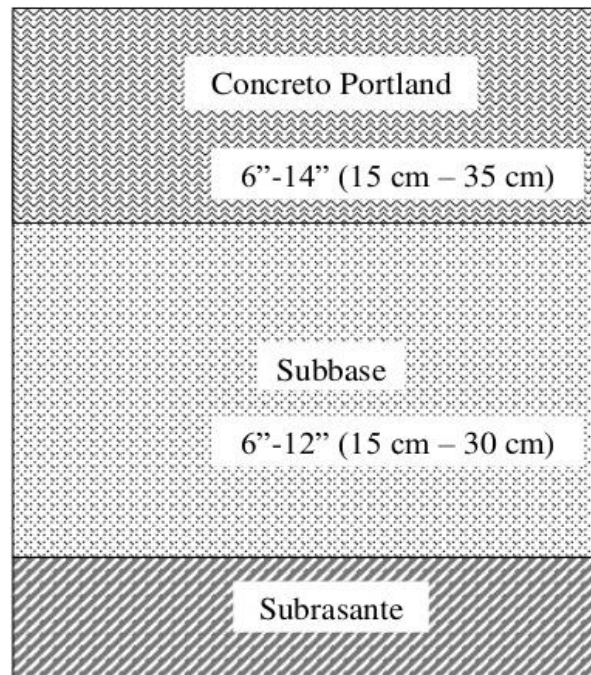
Fuente: Introducción a la Ingeniería de Pavimentos,
